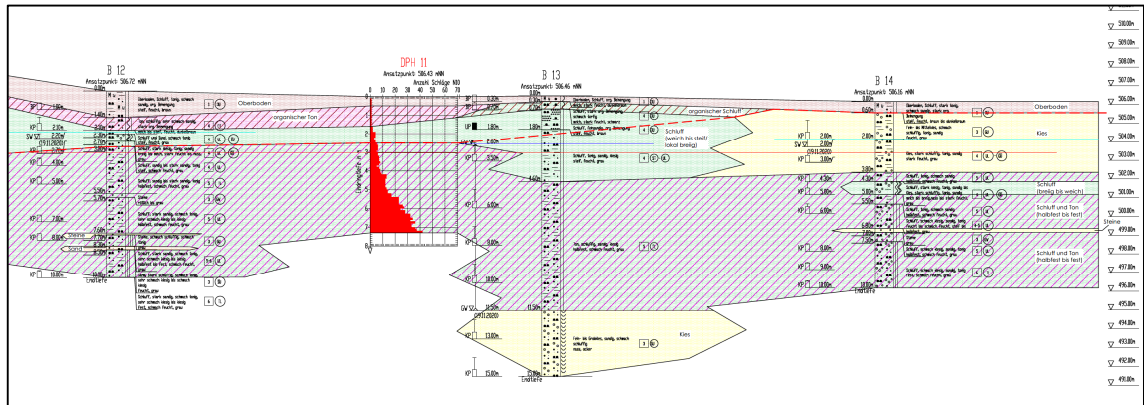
Ausschnitt geotechnisches Baugrundprofil B-B [G2]
